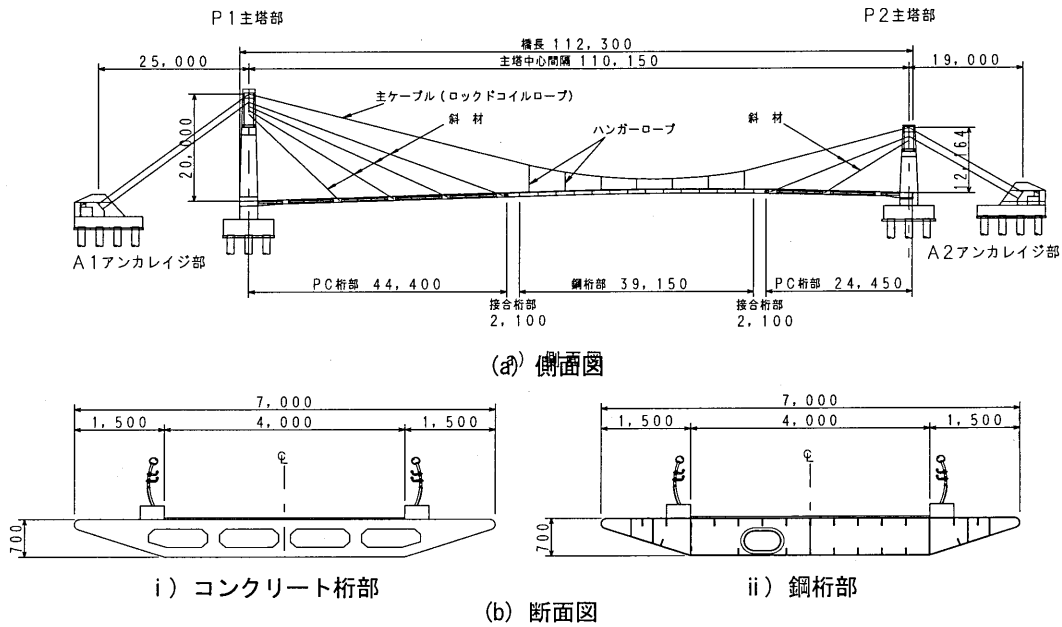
なぎさブリッジ(寸法単位:mm)
